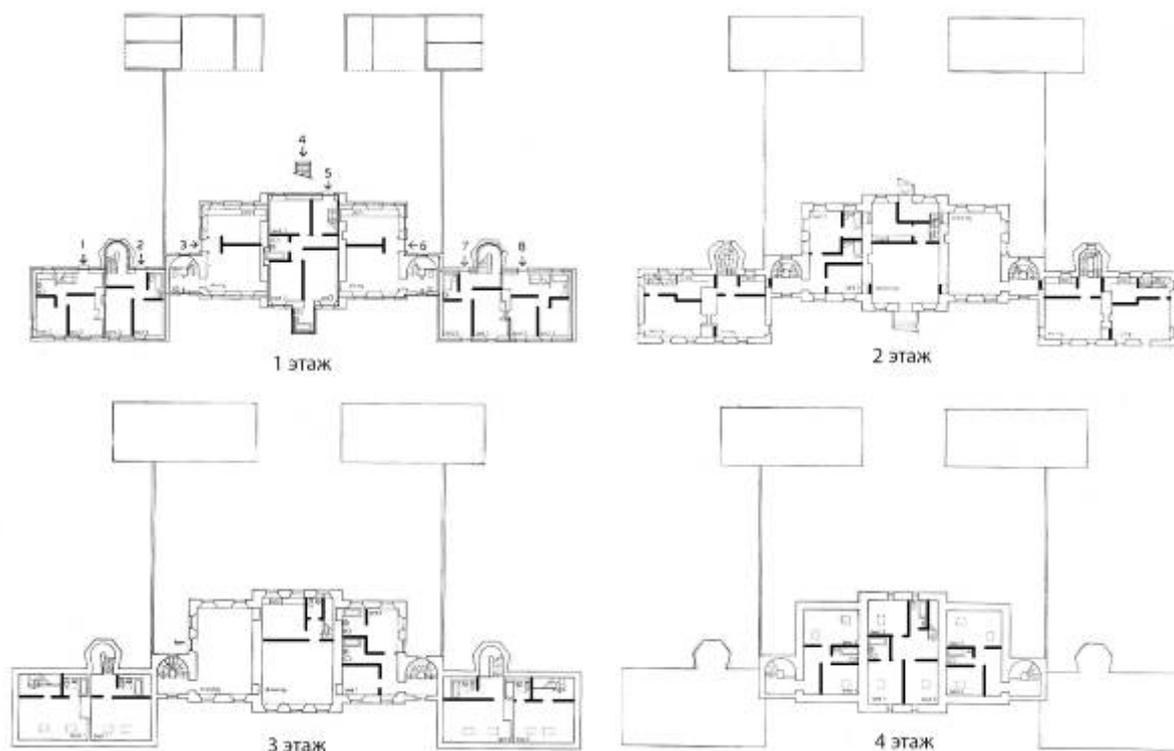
House of Gray. Схемы перепланировки этажей. Толстая заливка показывает новые перегородки<sup>8</sup>.
